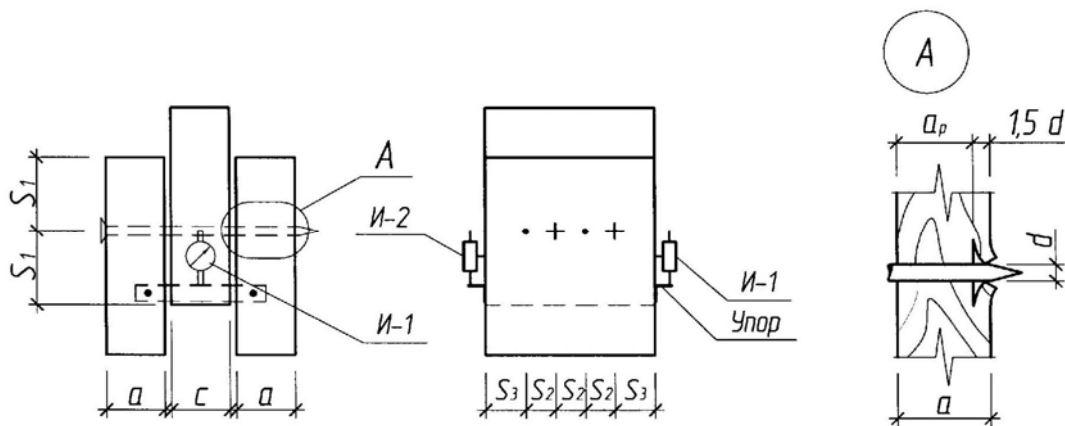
Конструкция образца гвоздевого соединения с размещением приборов
